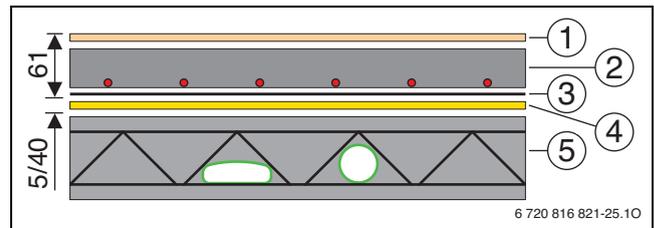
Canale piatto/tondo in soffitto in cemento grezzo (quote in mm)
